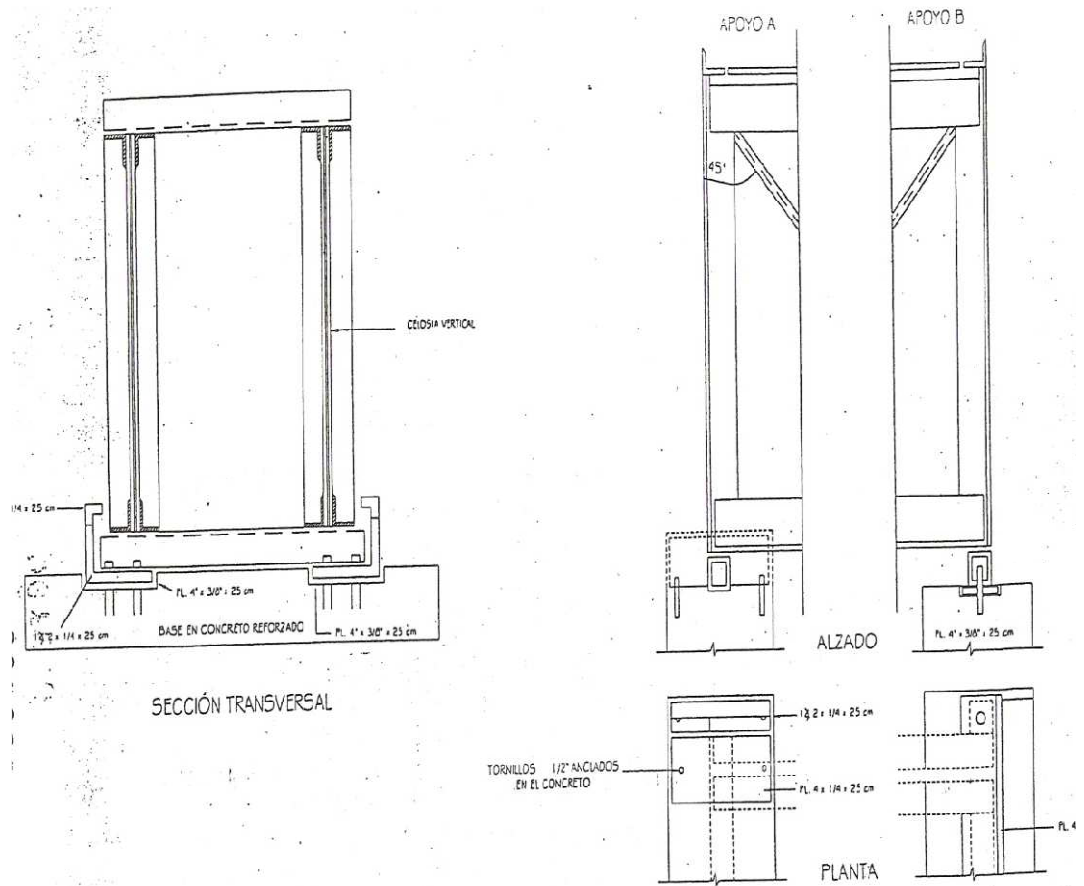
Detalles de los apoyos en los muros de la Cercha Metálica, Imagen extraída Diseño de Cerchas de ETB.
